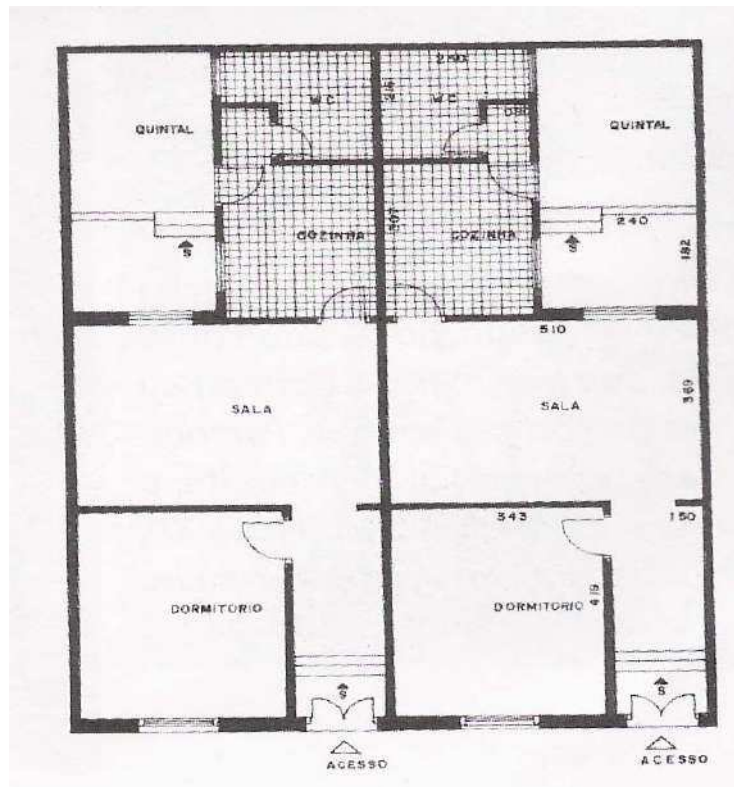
Planta tipo de vila em S.Paulo (1910)
